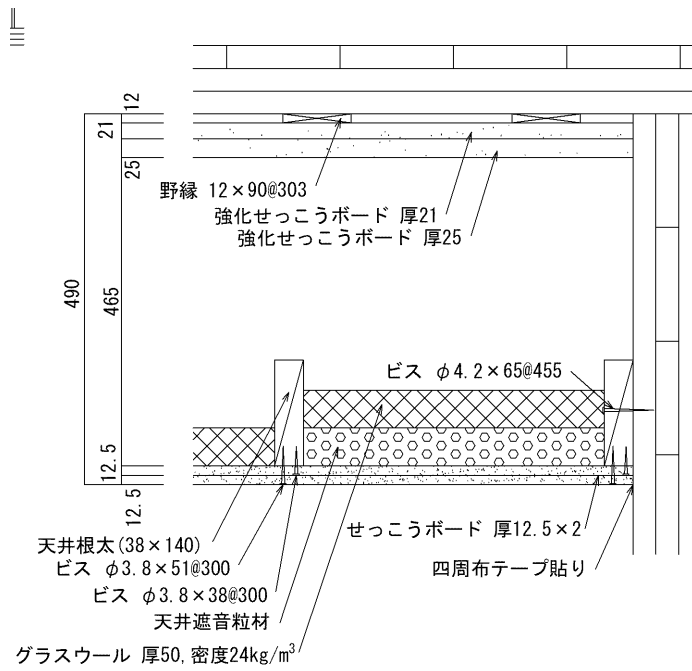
独立二重天井Cの断面仕様 (試験体 A9)
